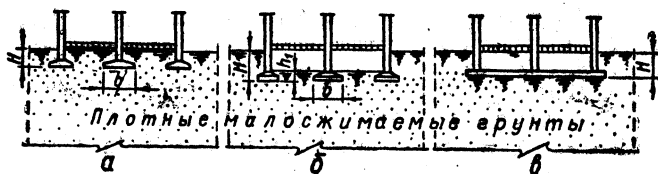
Типы фундаментов зданий с массивными стенами при плотных малосжимаемых грунтах:
